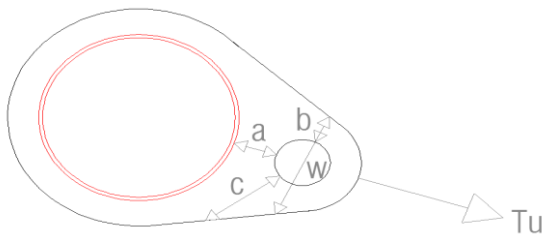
Nomenclatura de las dimensiones del elemento (Planos constructivos).
